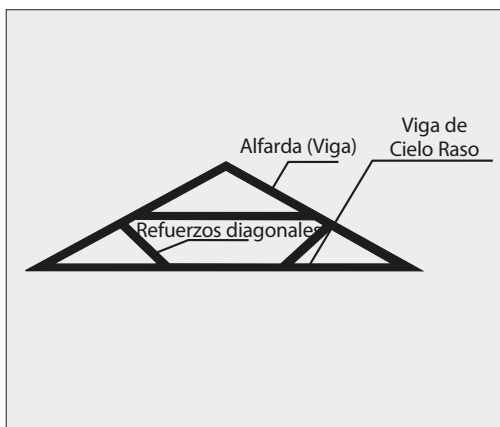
Construcción Convencional de Techos con Refuerzos Diagonales Conectados a las Vigas del Techo.
